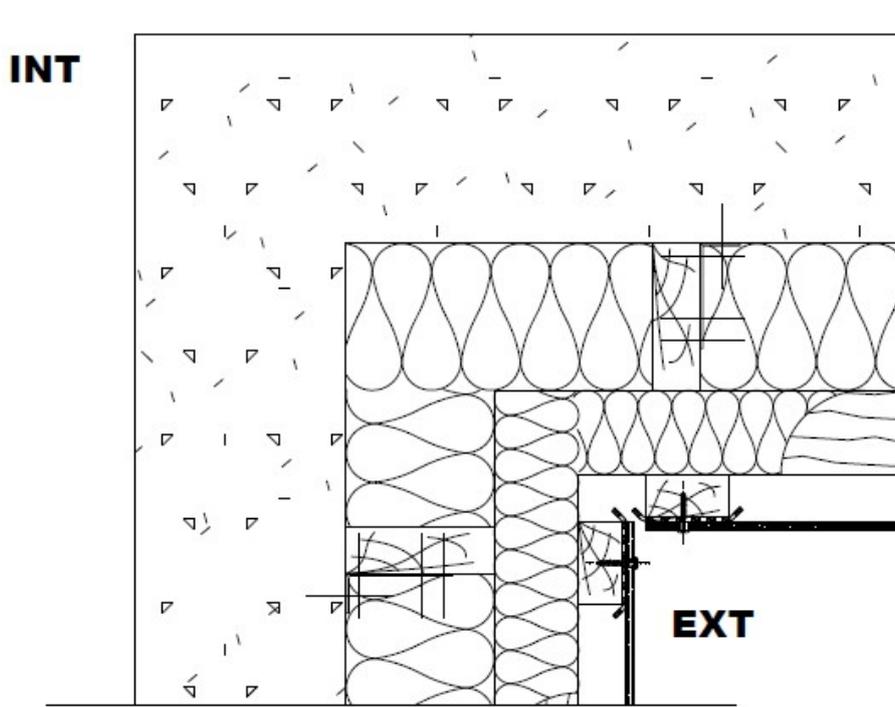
Traitement sur BA en multi réseau - Coupe horizontale angle rentrant
